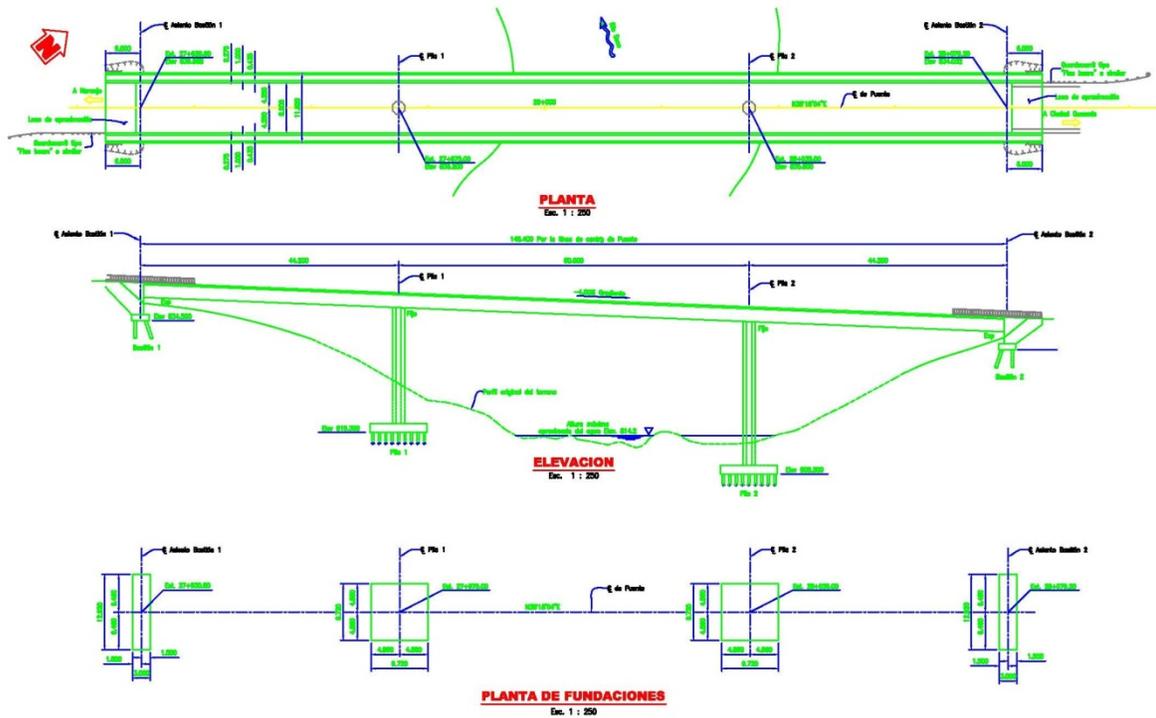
Plano sobre el puente sobre el Río Seco donde se identifican sus elementos.
